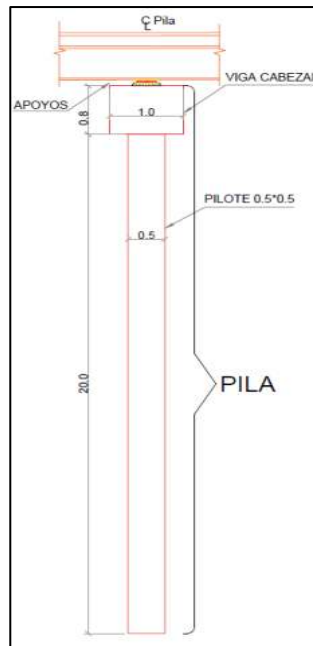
Sección transversal de la pila del puente sobre el estero Ñauza
